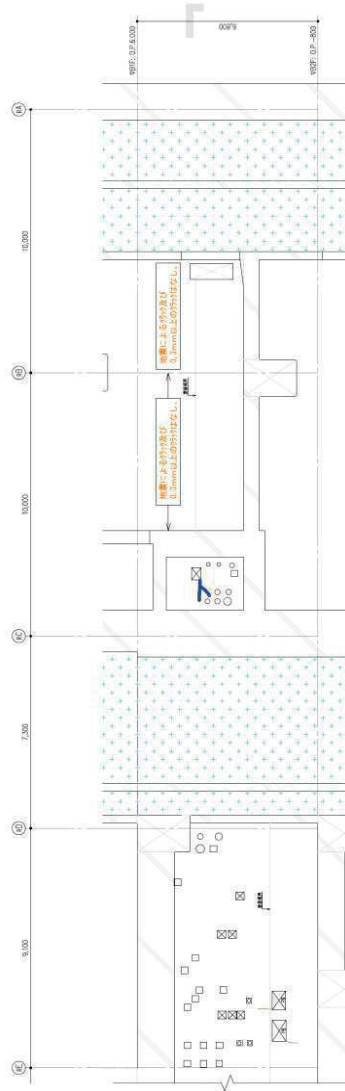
原子炉建屋のひび割れ分布 耐震壁 (10) 地下 3 階 シェル壁
